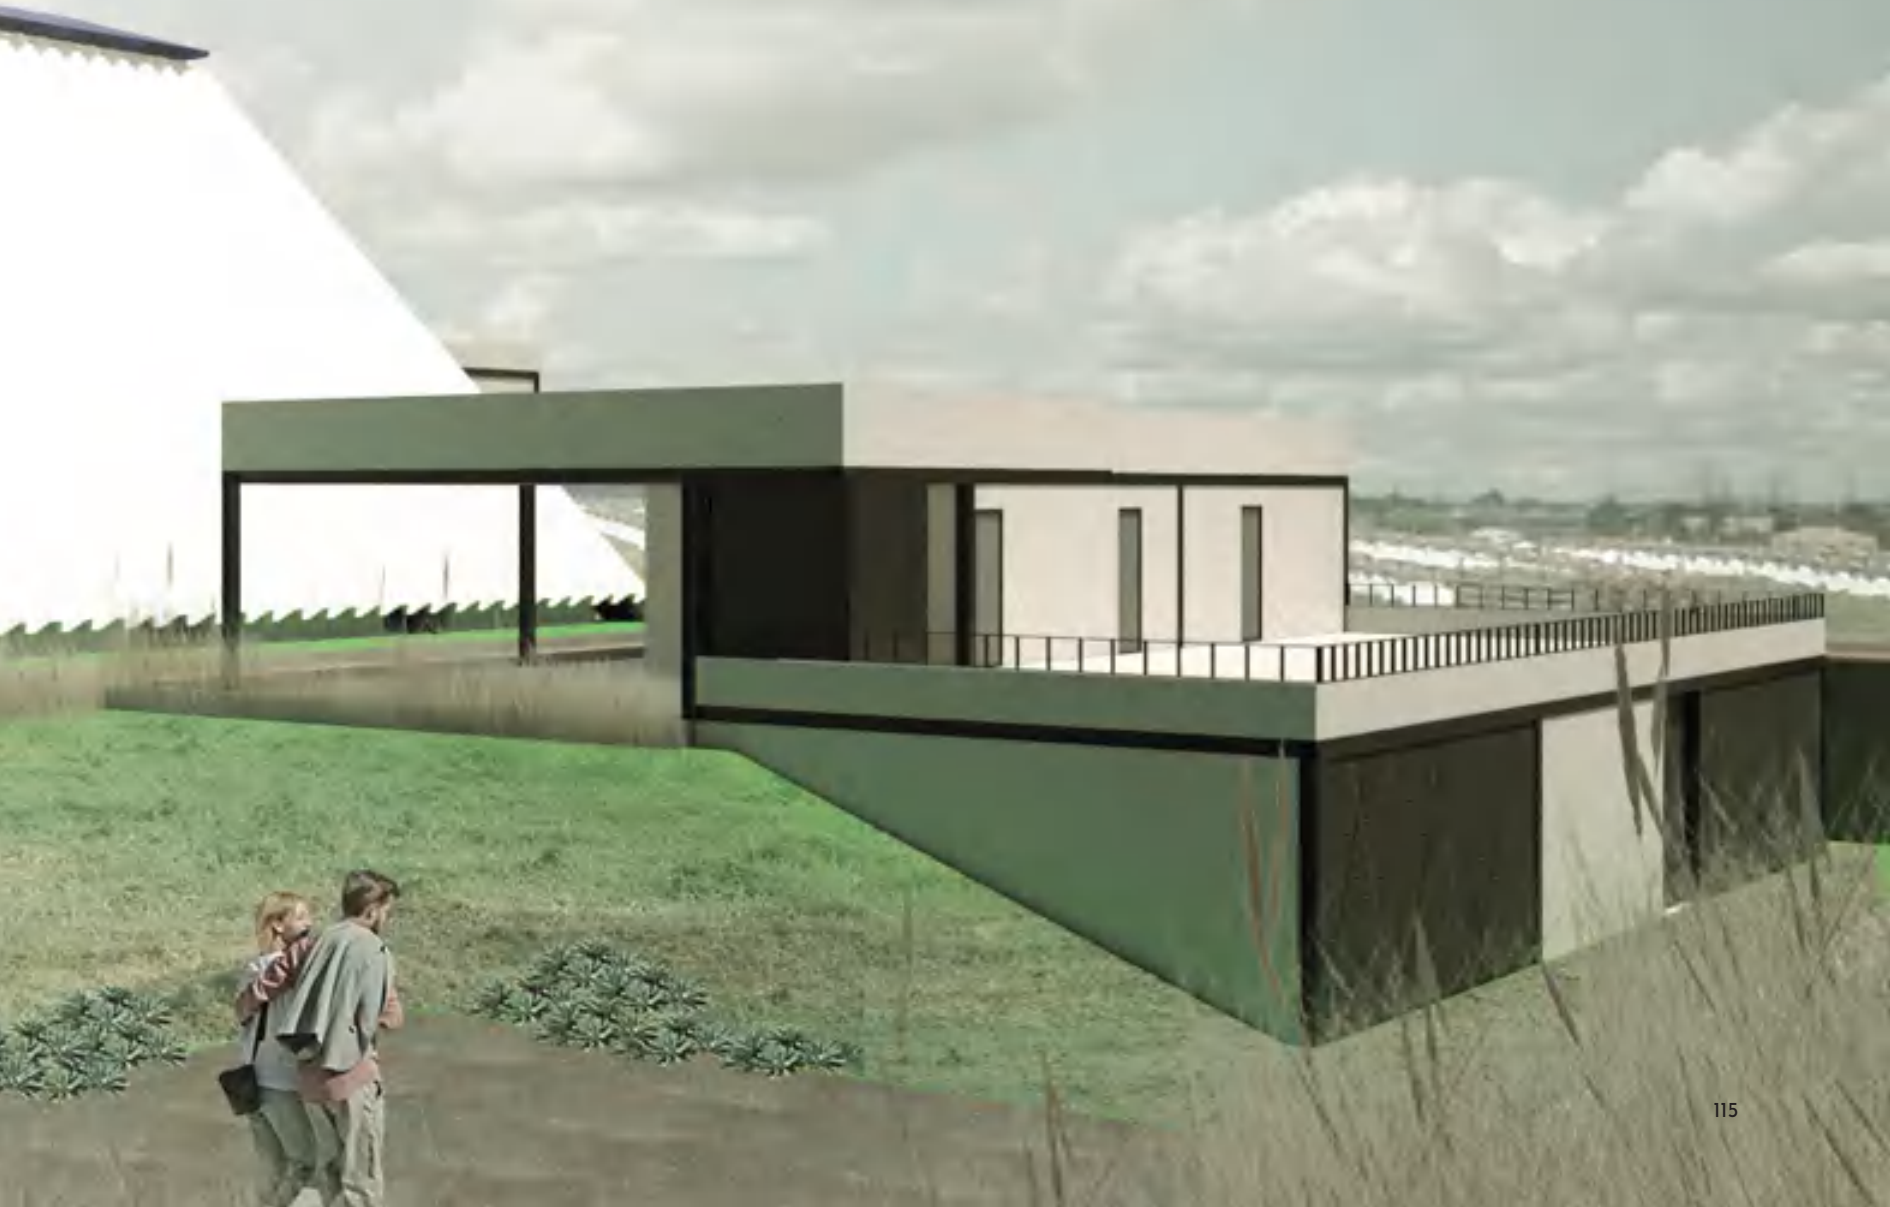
Fachada Lateral Bloco Ginásio e Bloco Inst. Sanit. Anfiteatro
